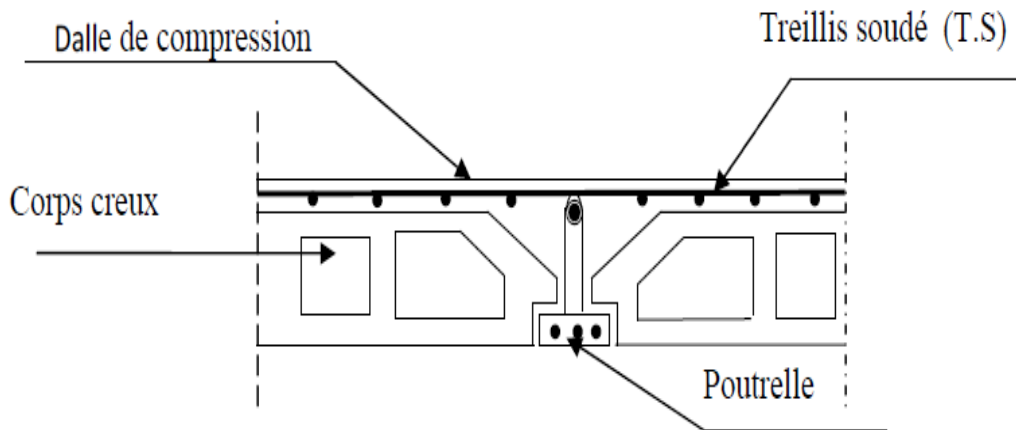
Coupe verticale sur un plancher en corps [22].
